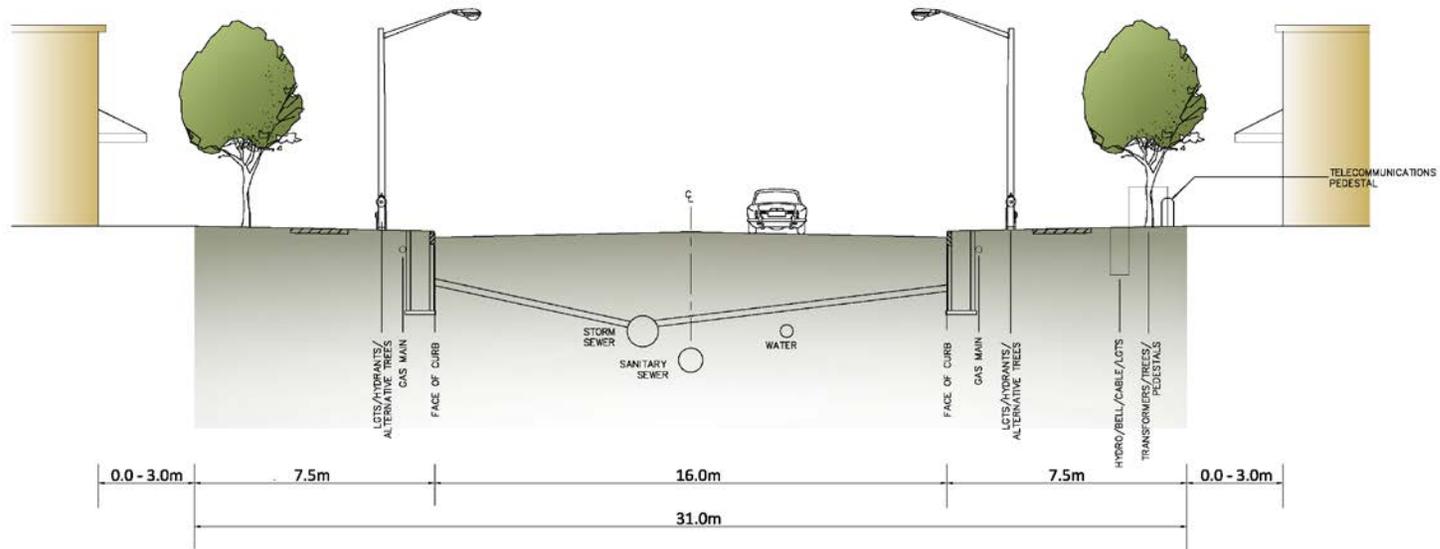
Section transversale d'une route collectrice principale (31 m à l'intersection de la route 174 d'Ottawa)
